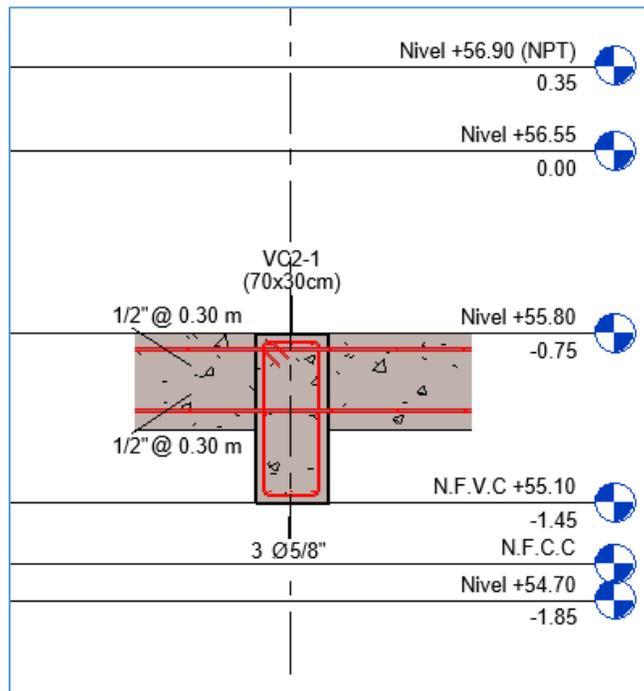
Detalle de Viga de Cimentación según Expediente Técnico.
